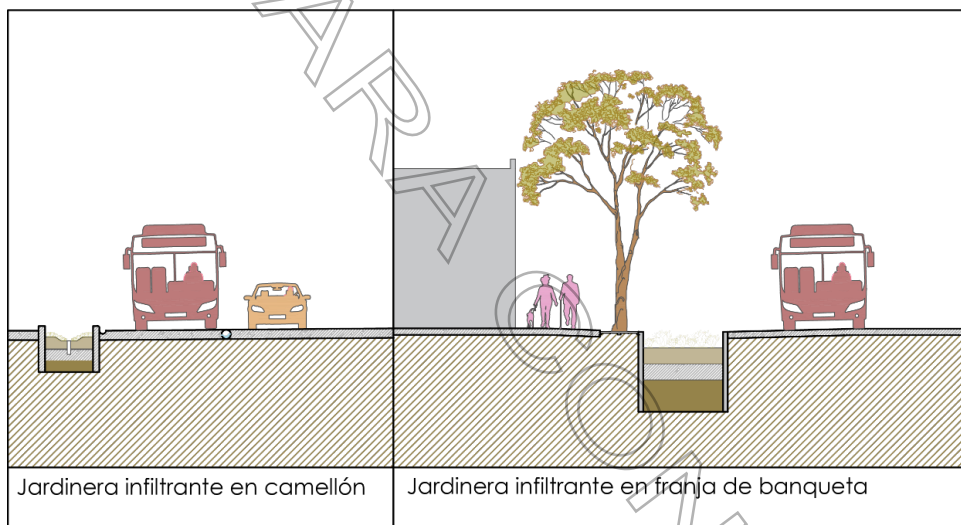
Vegetación en alcorque y en jardinera (planta y secciones)
